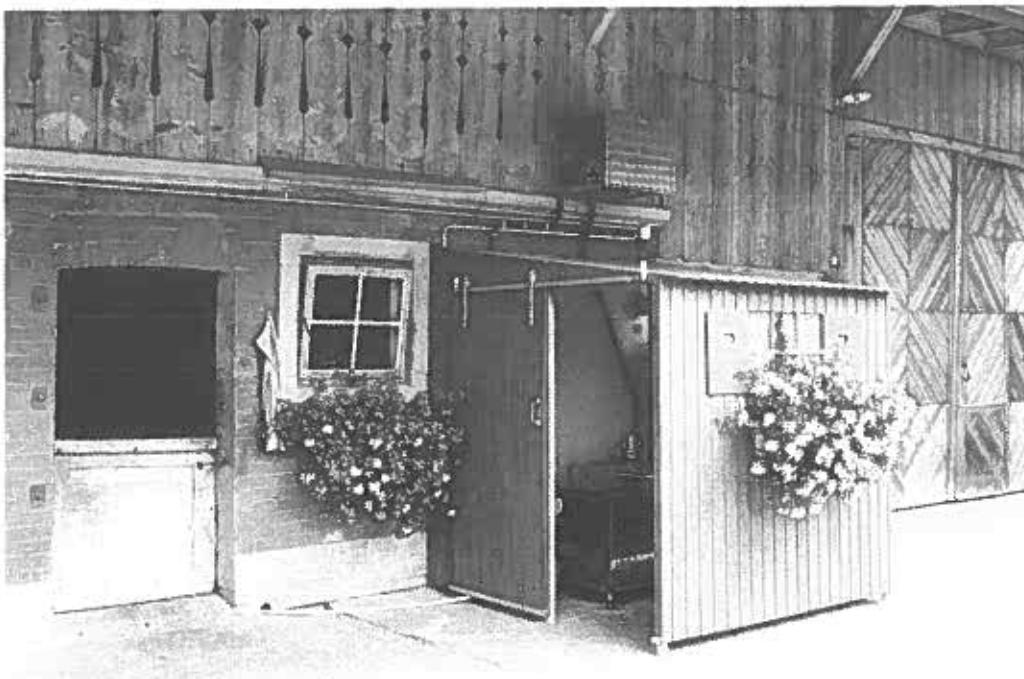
Milchlagerraum mit Kühlwanne; Kühlaggregat über dem Milchlagerraum
